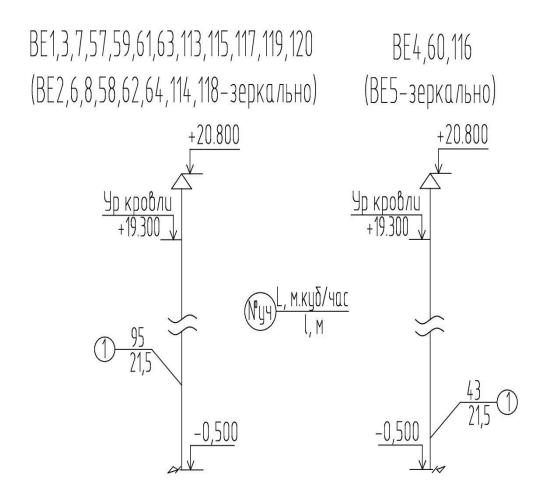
Расчетная схема вытяжной вентиляции кладовых помещений
